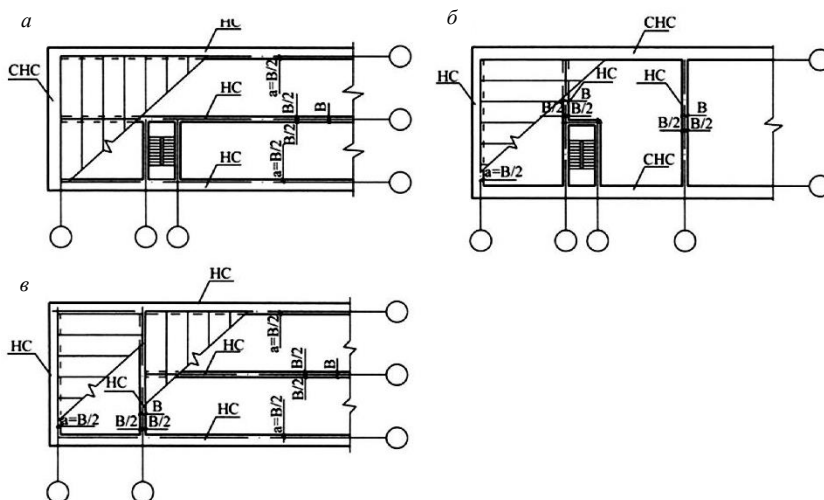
Конструктивные схемы зданий с несущими стенами: продольными (а); поперечными (б); продольными и поперечными (в)
